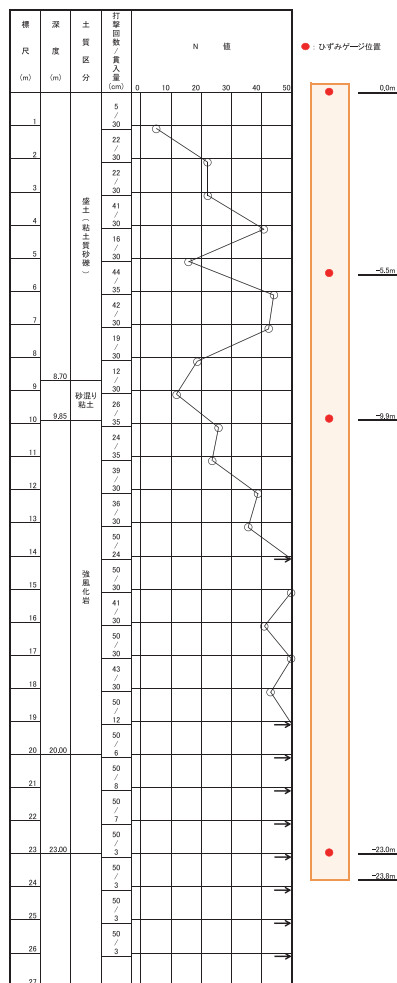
中掘り杭工法コンクリート打設方式施工・載荷試験の柱状図
